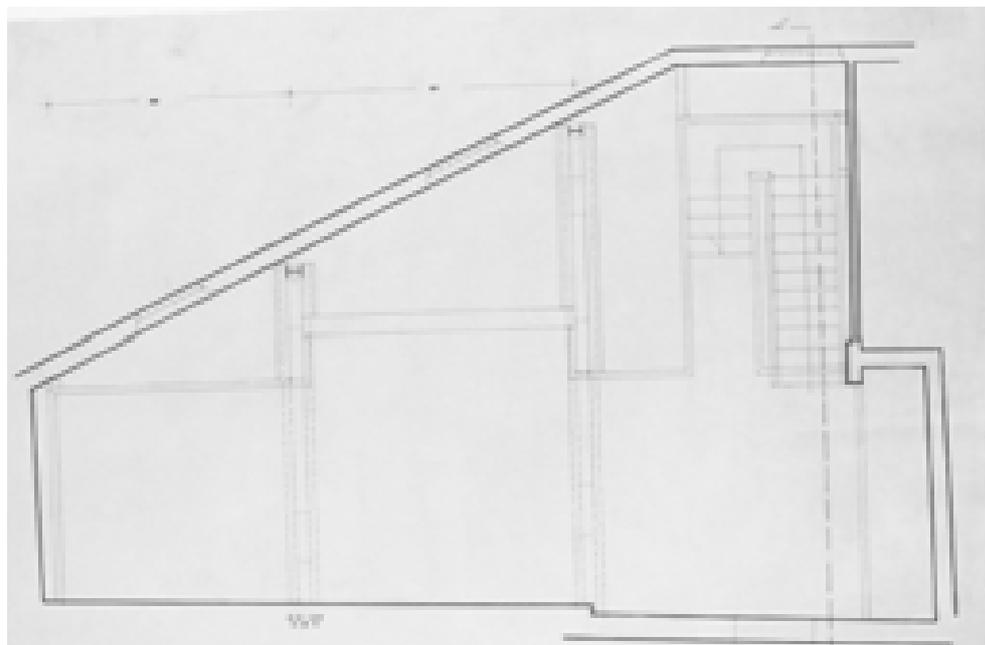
Pianta quota esecutivo – s.d. (AABS-94.194)
